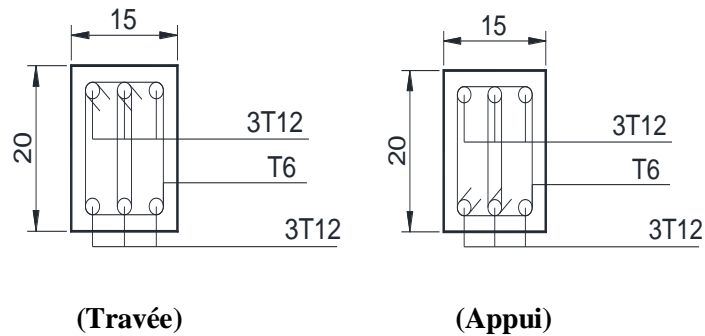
Ferrailage d'une poutre noyée secondaire 15x20cm (plan régulier)
